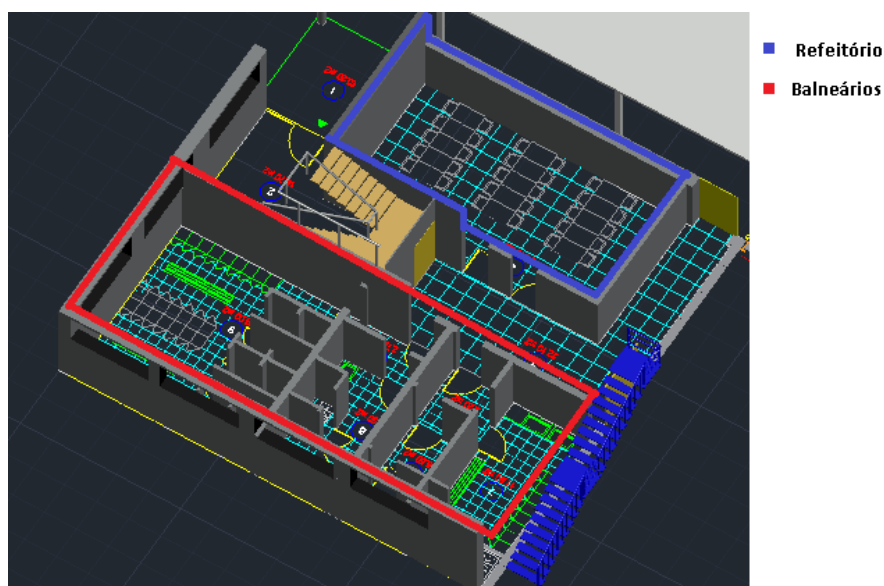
Representação da planta do piso inferior em AutoCAD[3]
